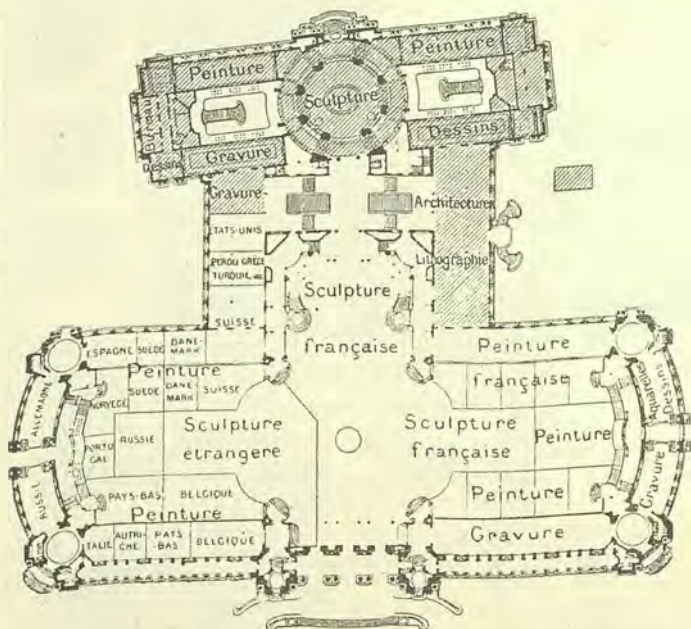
a. — Planimetria generale di Parigi del 1900.
